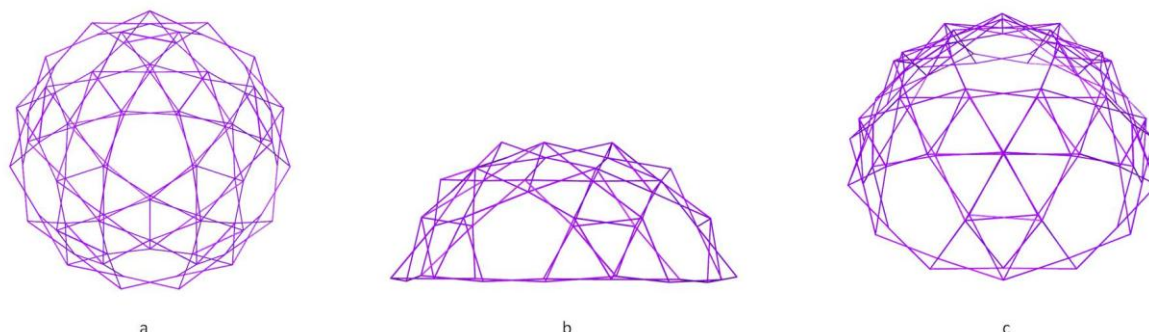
Geometría del domo desplegable D30. (a) Vista en planta. (b) Vista lateral. (c) Vista isométrica.
